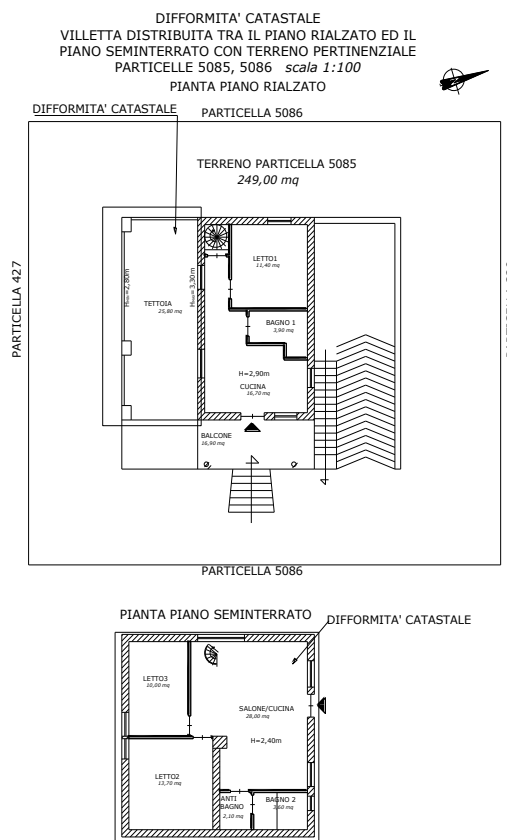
planimetria delle difformità catastali del piano rialzato e del piano seminterrato della villetta
